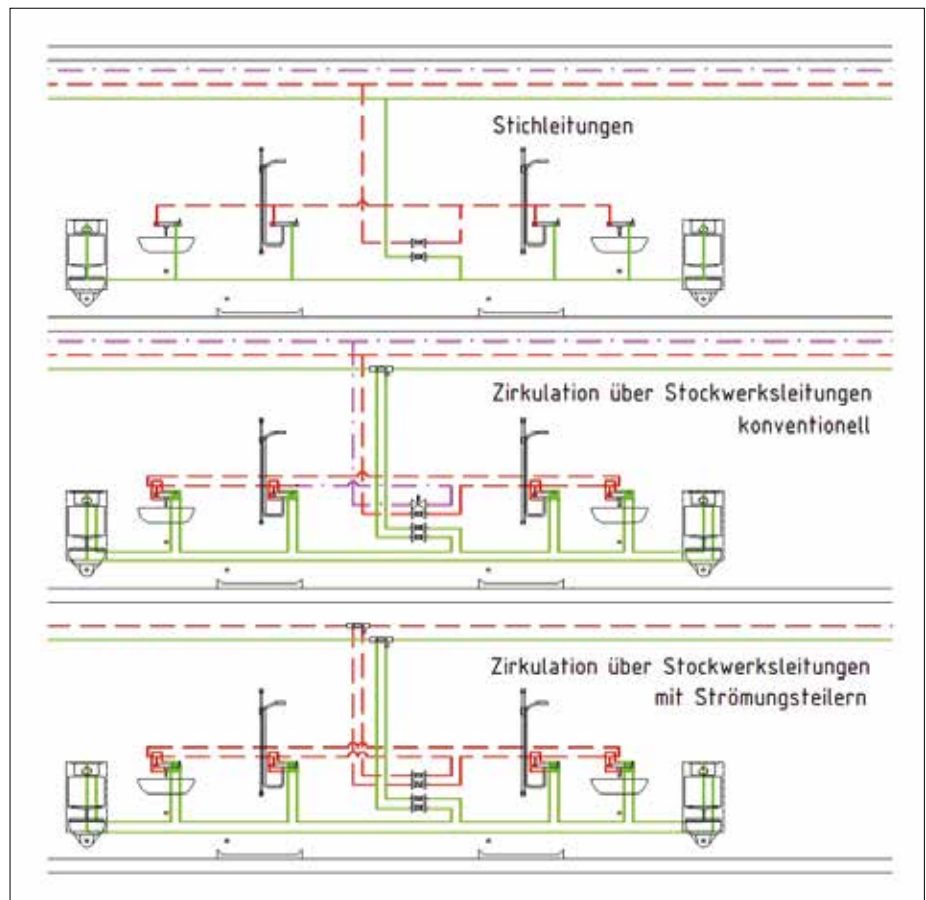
Stockwerksinstallationen für Zweckgebäude
